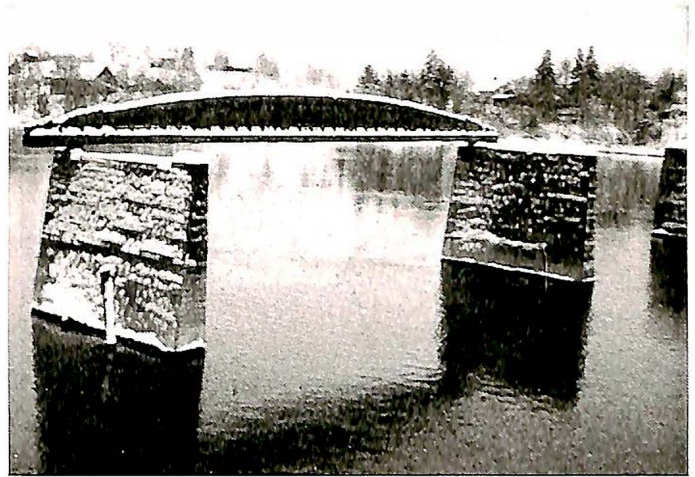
Den første betongbjelken er lagd på plass på lagra.
